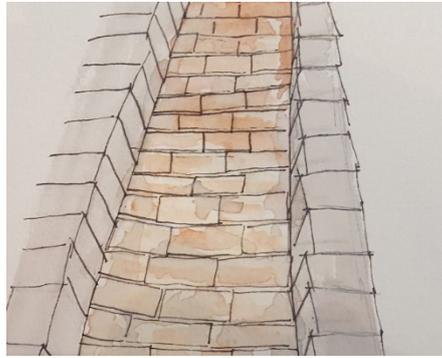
Croqui do encaixe dos tijolos no canal coletor da água do telhado da Olaria.
